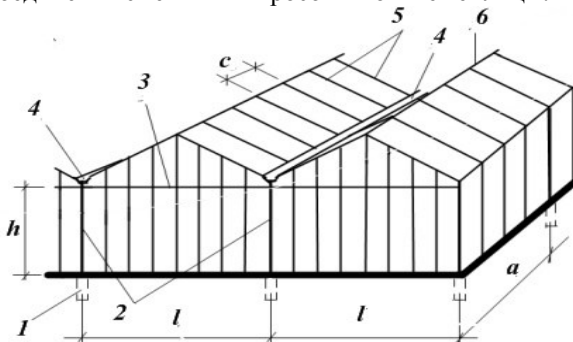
Конструктивная схема блочной теплицы: 1 – фундамент, 2 – стойка из прокатного двутавра № 10, 3 – затяжка, 4 – лоток из гнутого швеллера для удаления осадков, 5 – шпросы из сдвоенных уголков, 6 – коньковый прогон
